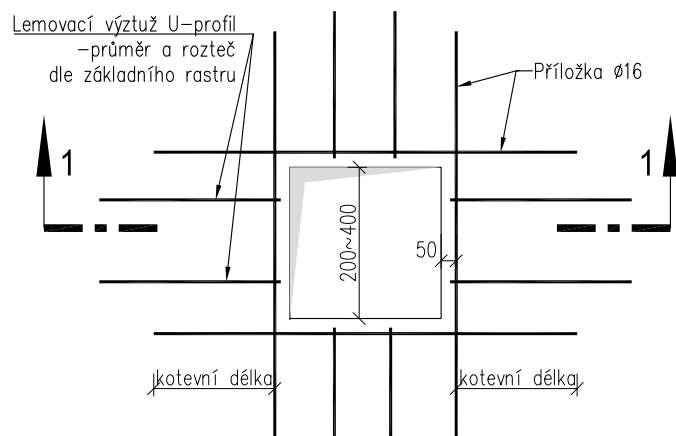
DETAIL LEMOVÁNÍ OTVORU VE STĚNĚ (NADPRAŽÍ S OZUBEM)
